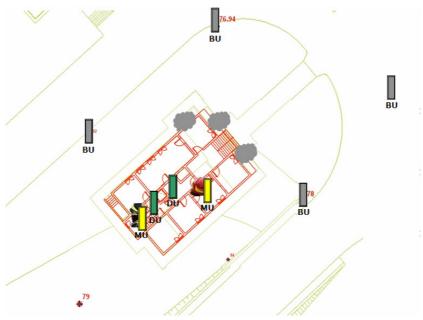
Posizionamento delle BU, MU e DU nella Fire House
